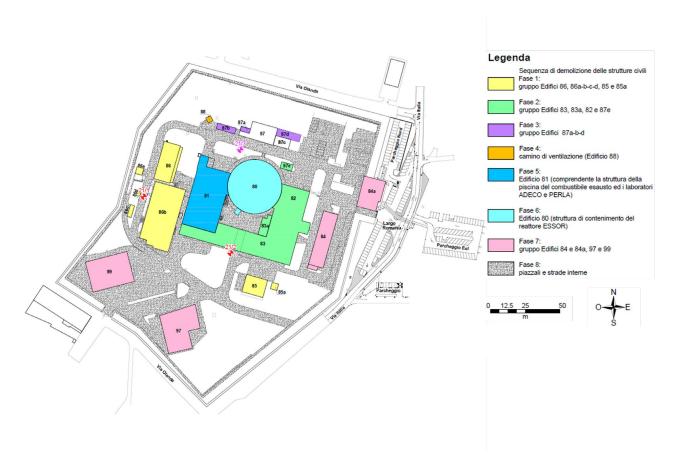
Area di cantiere e fasi di demolizione delle strutture civili
